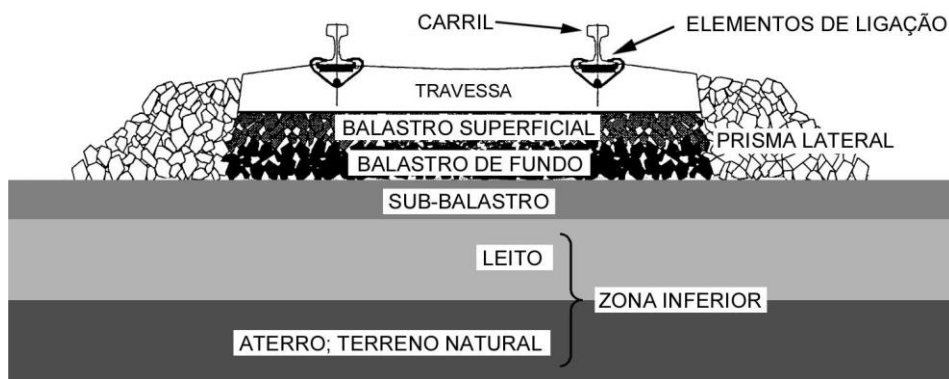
esquema estrutural do perfil transversal da via balastrada, retirado de (Fortunato 2005)
